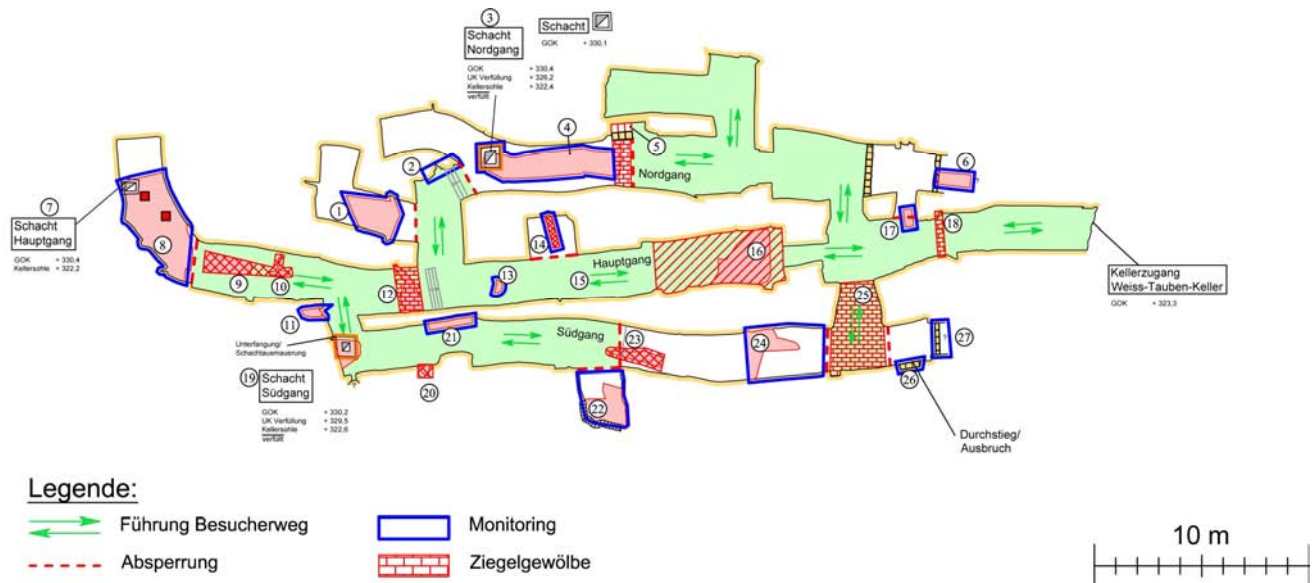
Grundriss zur Nutzung und Sanierung des Weiß-Tauben-Kellers
